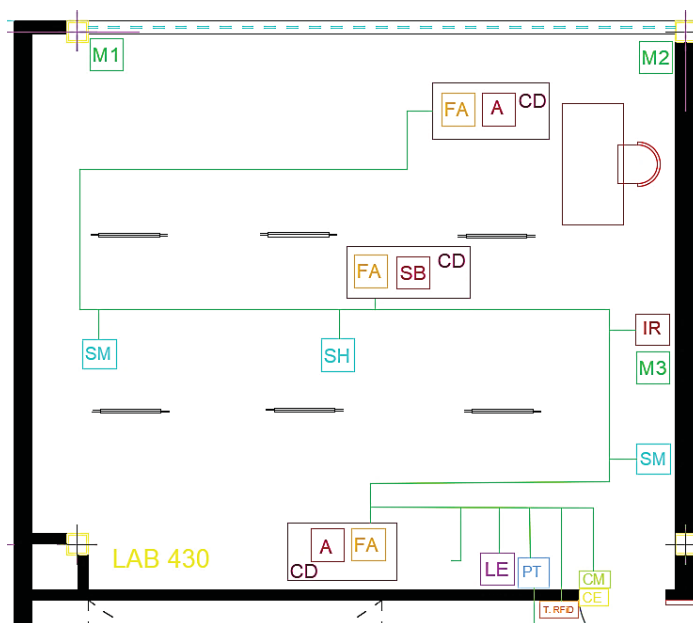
Corte plano control de acceso y seguridad de un laboratorio
